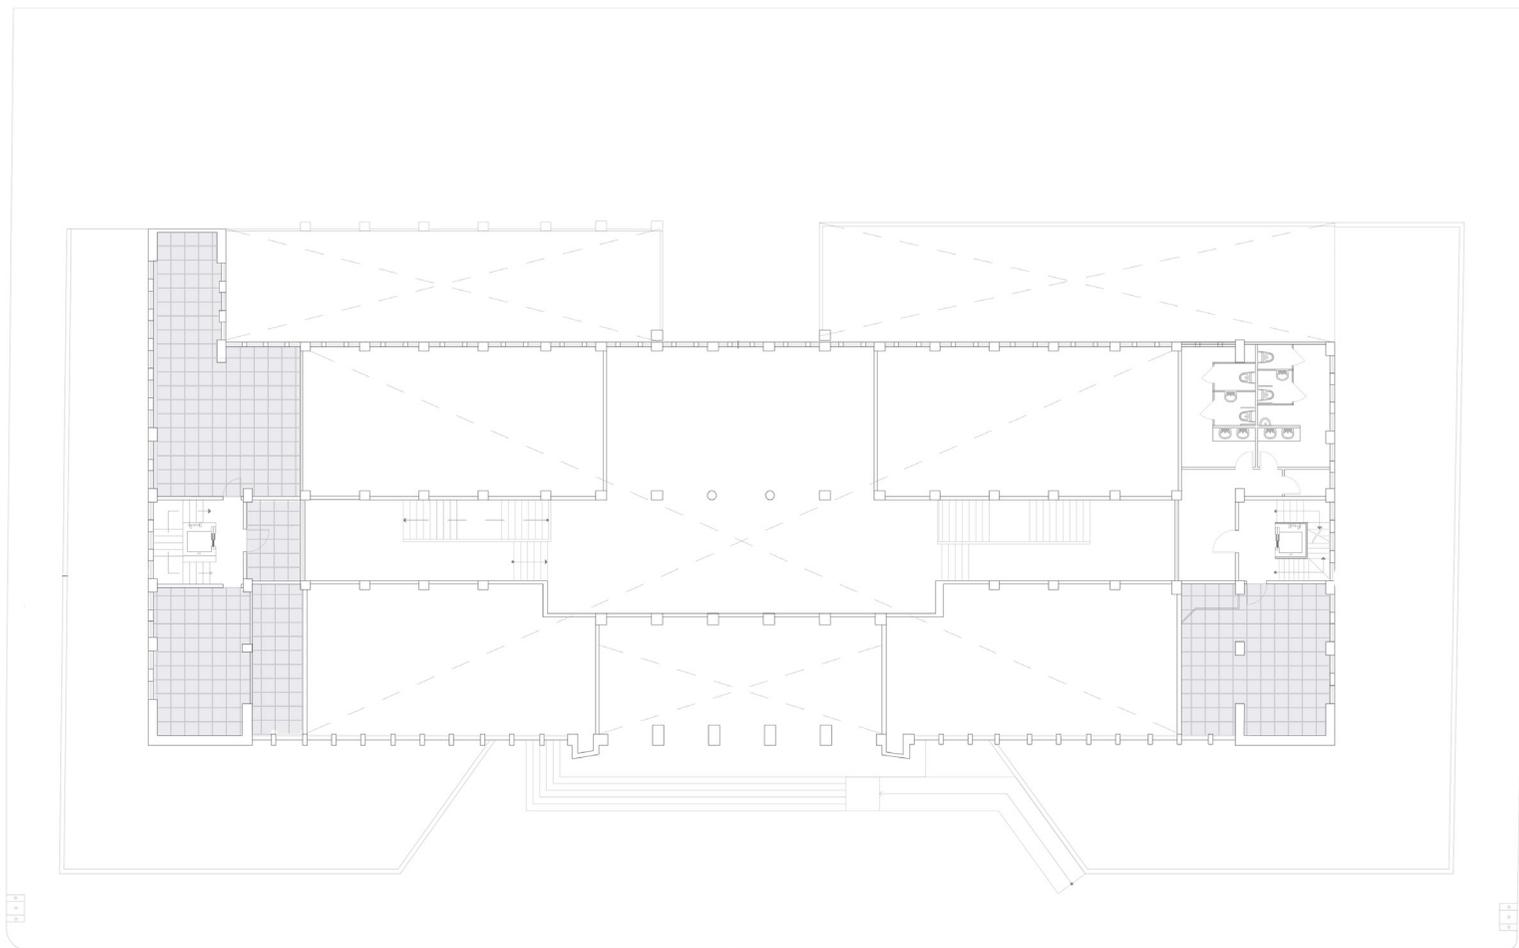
Plano de Tumbado - Planta Mezzanine 2
